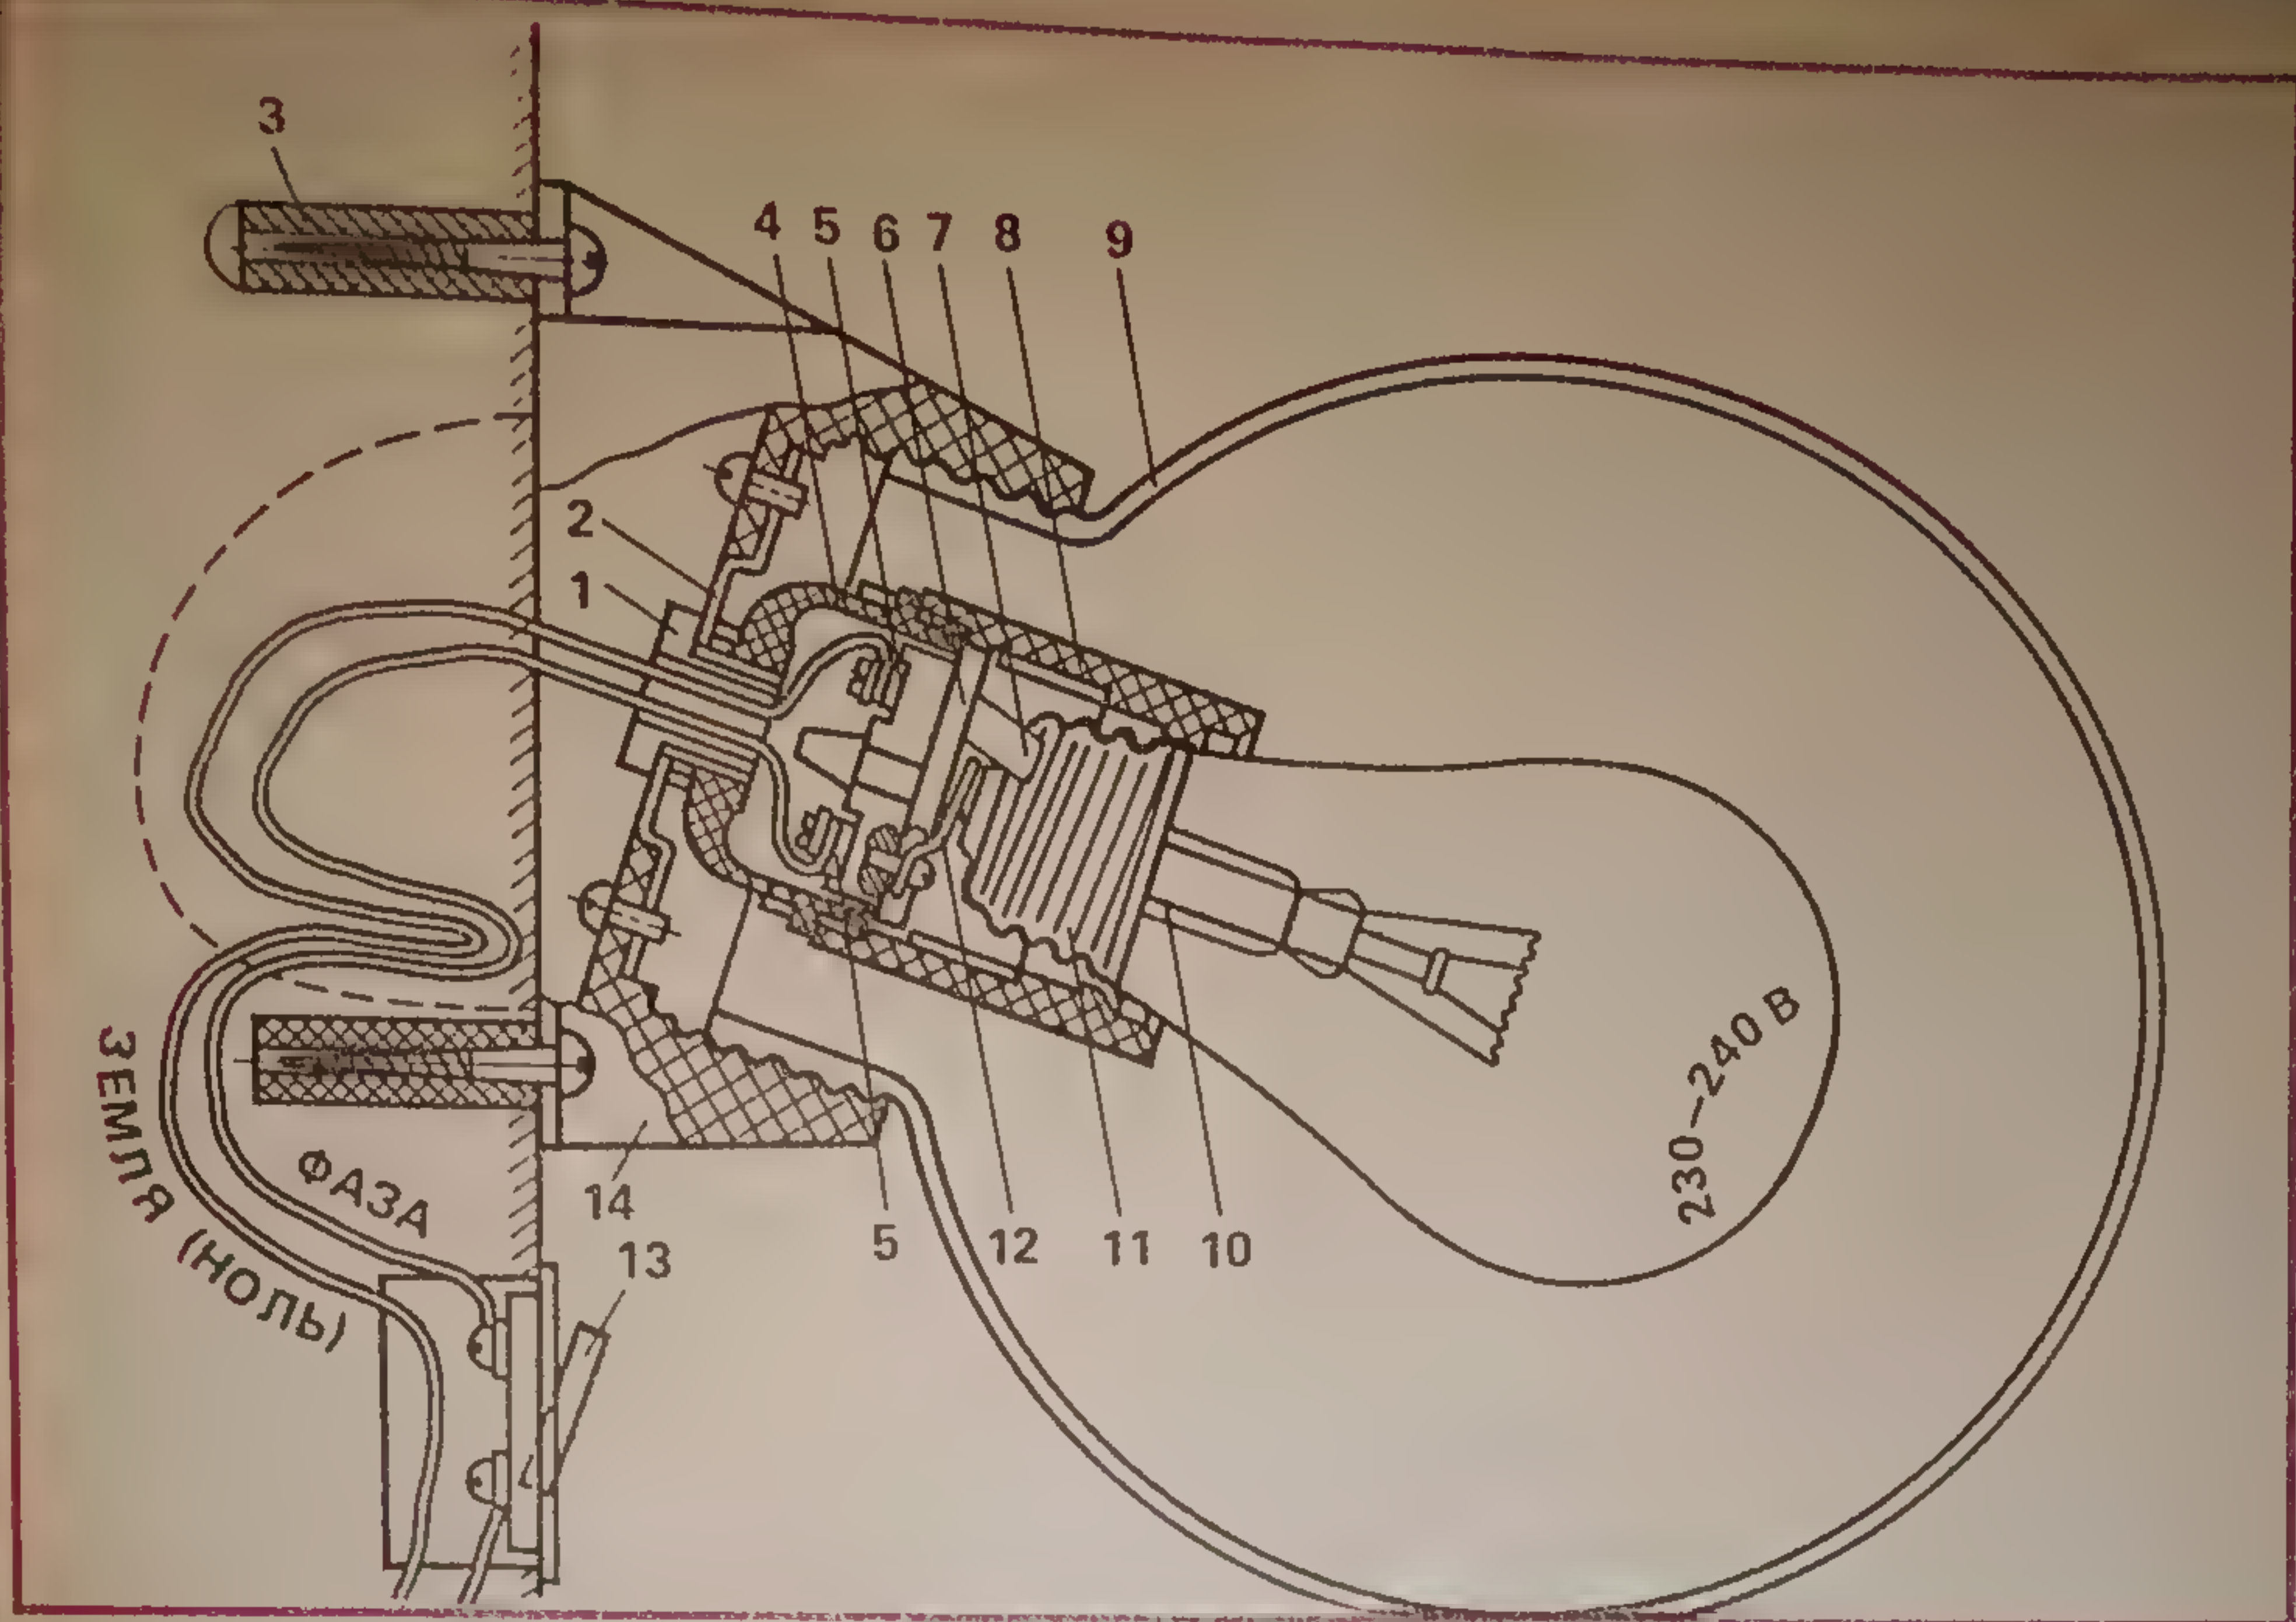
Настенный светильник ванной комнаты и туалета: 1 — втулка; 2 — накладка; 3 — дюбель; 4 — пятка патрона; 5 — спецдеталь; 6 — вкладыш; 7 — периферийный пластинчатый контакт; 8 — юбка патрона; 9 — колпак; 10 — электрод лампы; 11 — цоколь лампы; 12 — центральный пластинчатый контакт; 13 — клавиша выключателя; 14 — корпус
